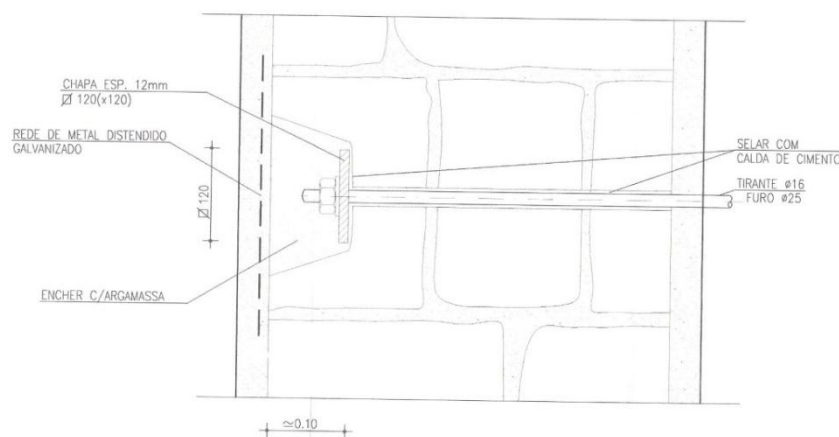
16 Ligação do tirante à parede de alvenaria de pedra, [37].
